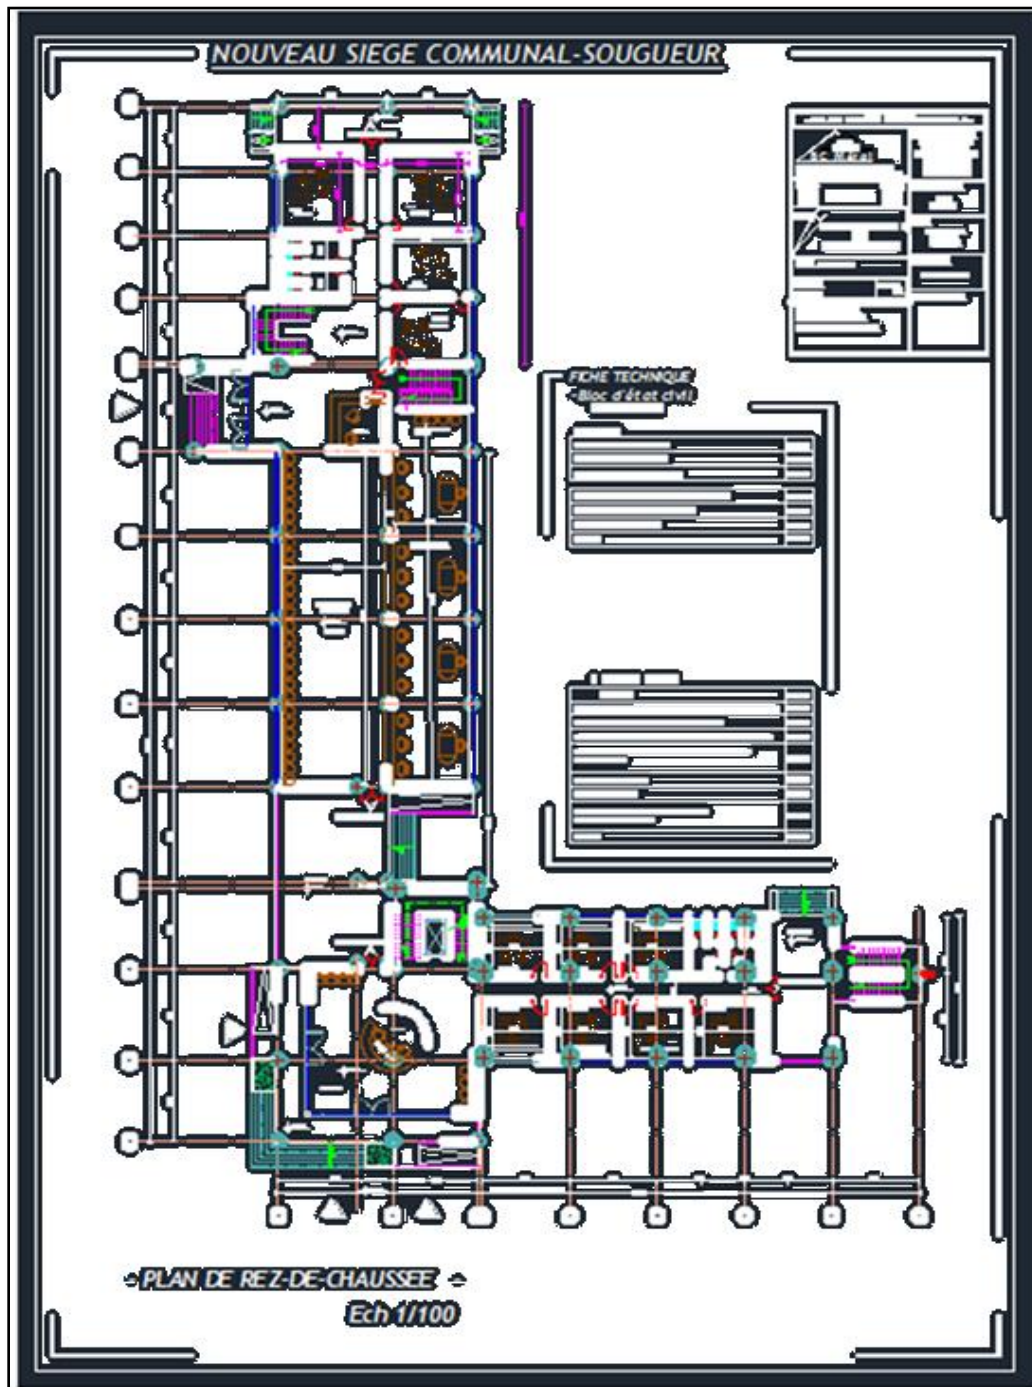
vue en plan niveaux R.D.C du siège APC (04 blocs).
